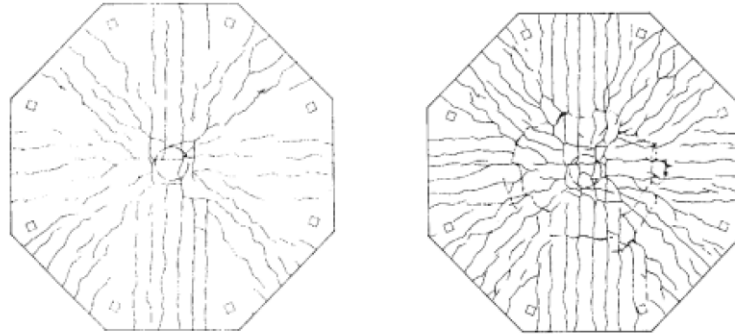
Surgimento de fissuras radiais e tangenciais em ensaios
